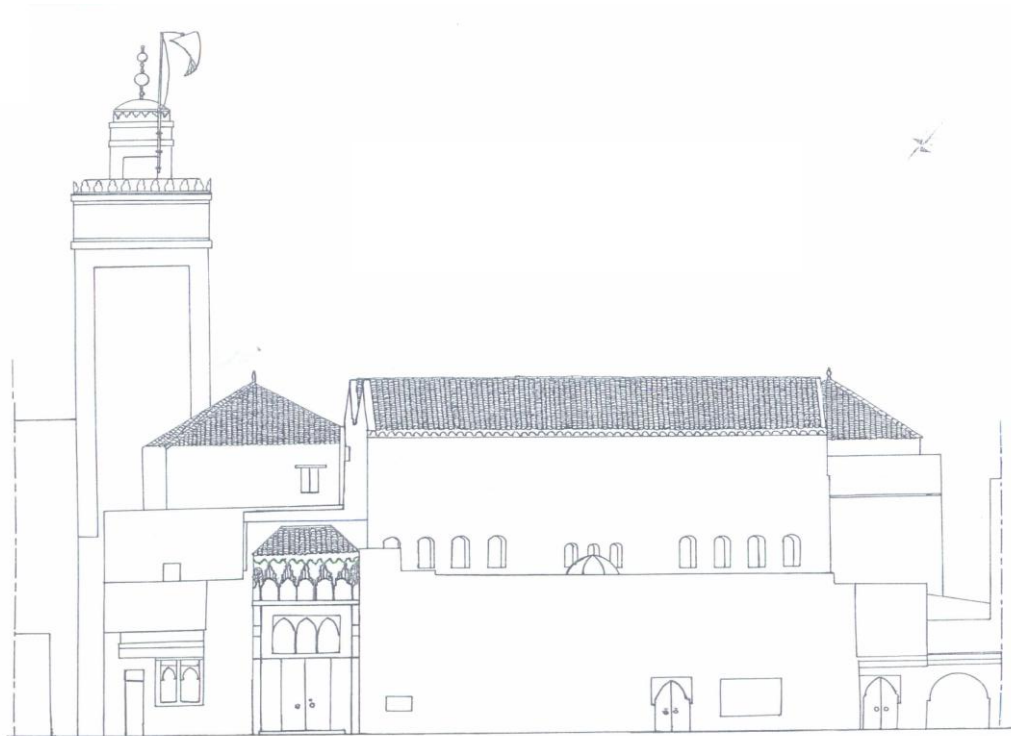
Plan de la façade & coupe de la médersa Al bou Inaniyya
